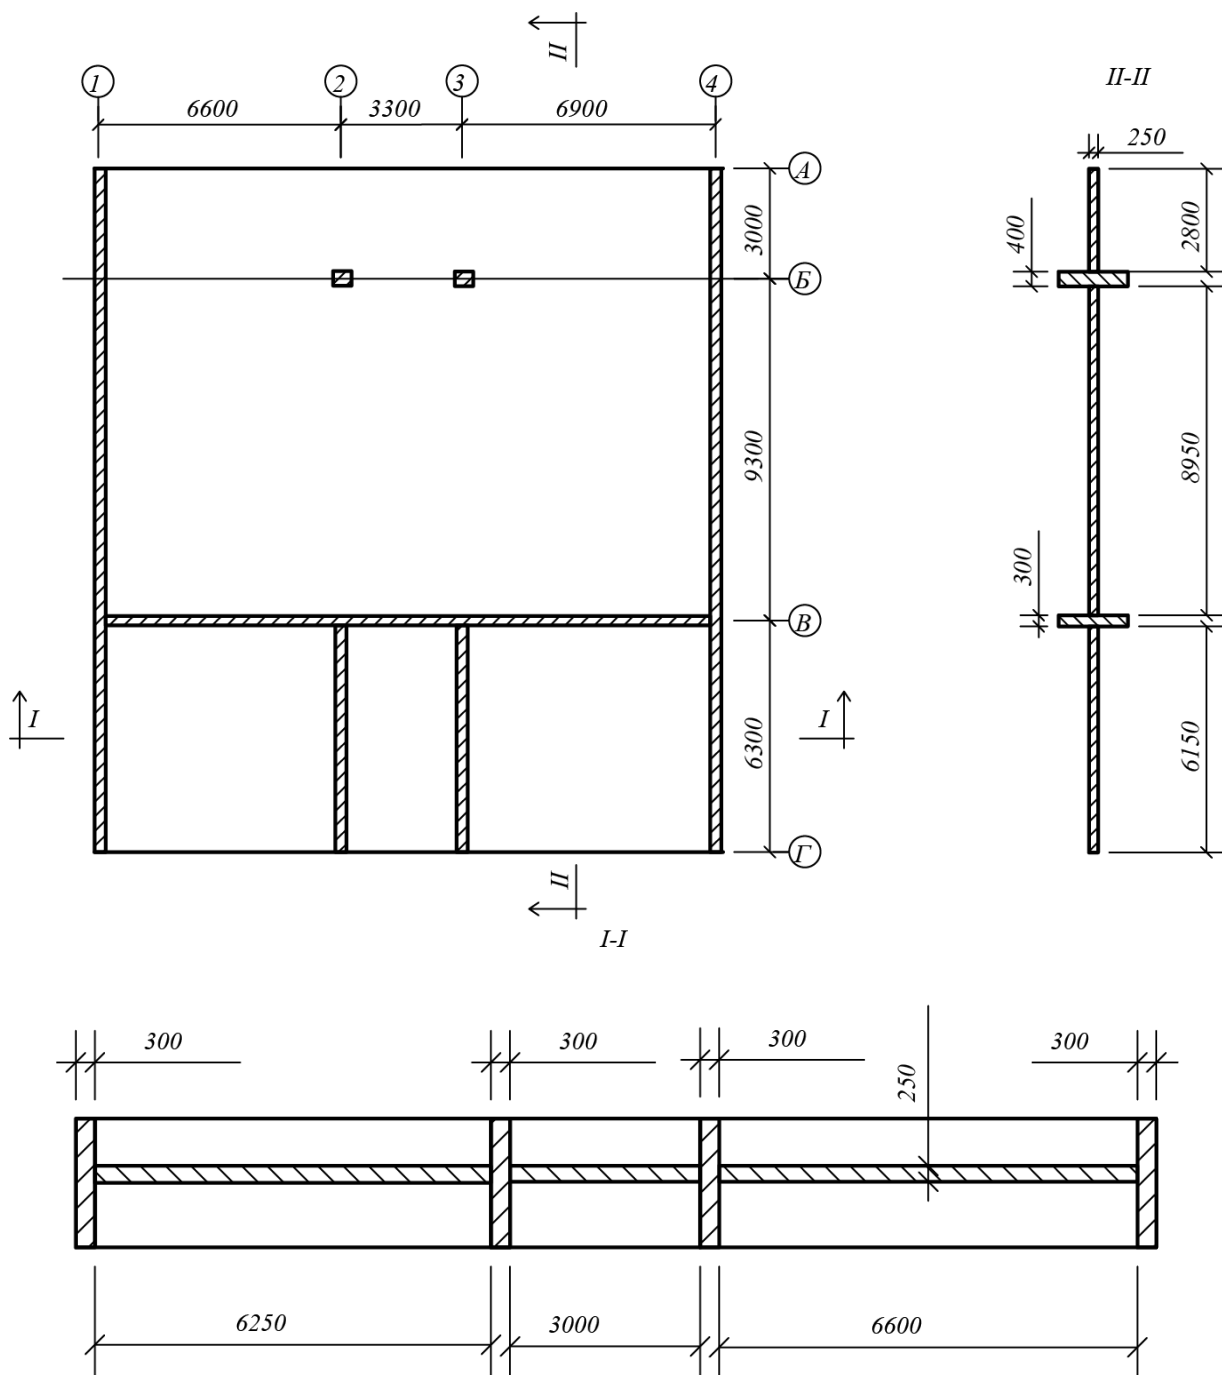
Геометрические размеры монолитной плиты перекрытия
